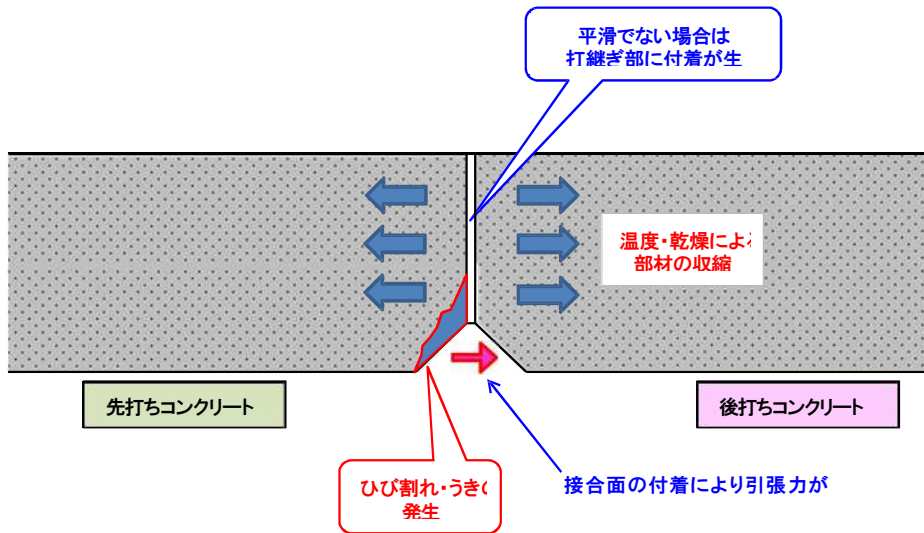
施工目地部の付着力によるひび割れ発生
